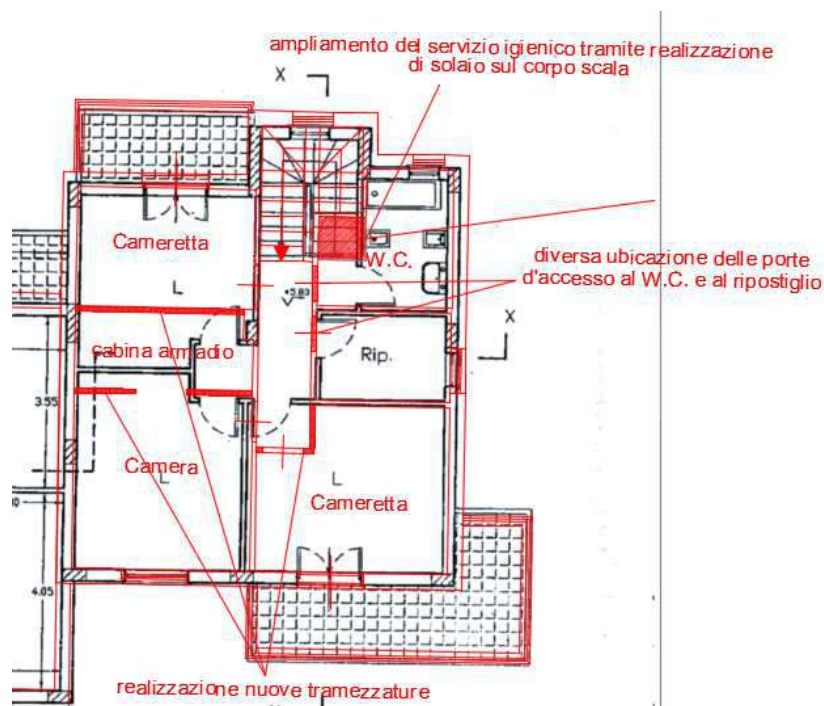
Sovrapposizione della planimetrie di rilievo di piano primo con la corrispettiva planimetria allegata alla Concessione edilizia
